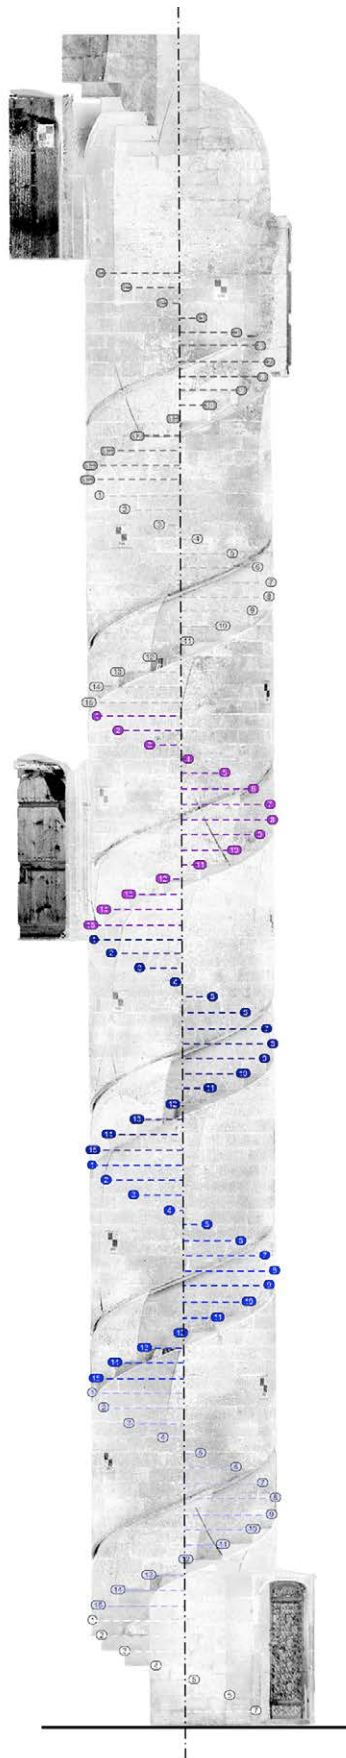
Schema di suddivisione delle rampe mediante l'indicazione dei profili degli scalini impostato sul prospetto della nuvola di punti. Elaborazione degli autori.
